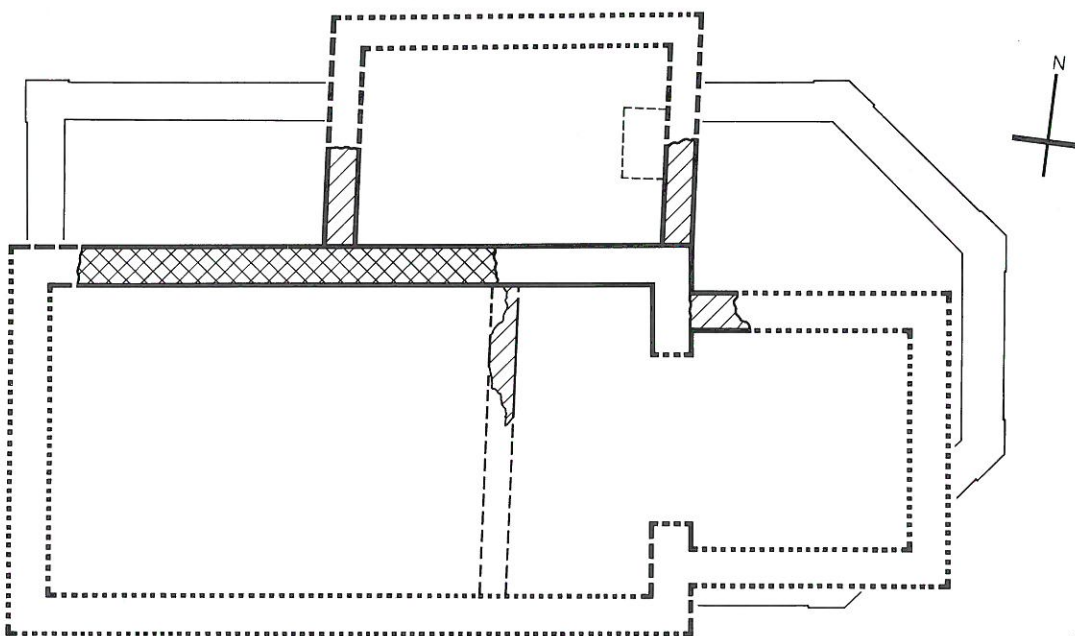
Grundriss der Anlage V (Fundament). Massstab 1:150.
